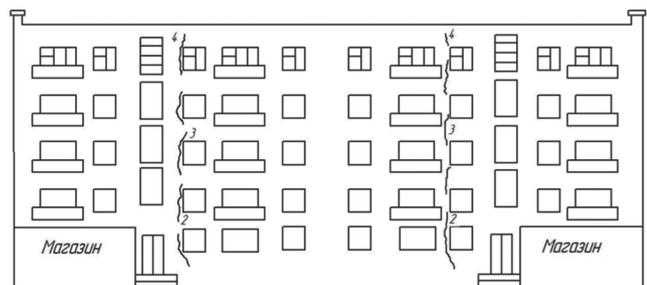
Дом 49. Трещины стены главного фасада
